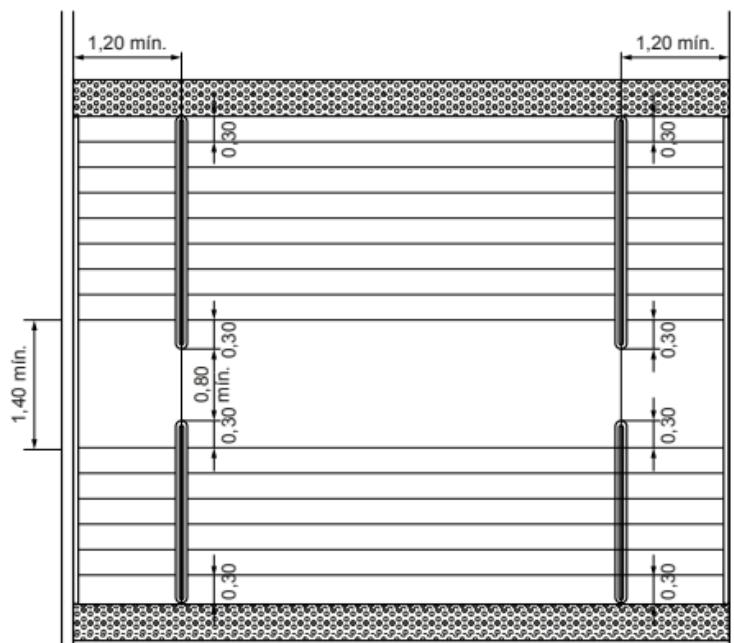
Corrimão intermediário em vista superior, dimensão em metros.
